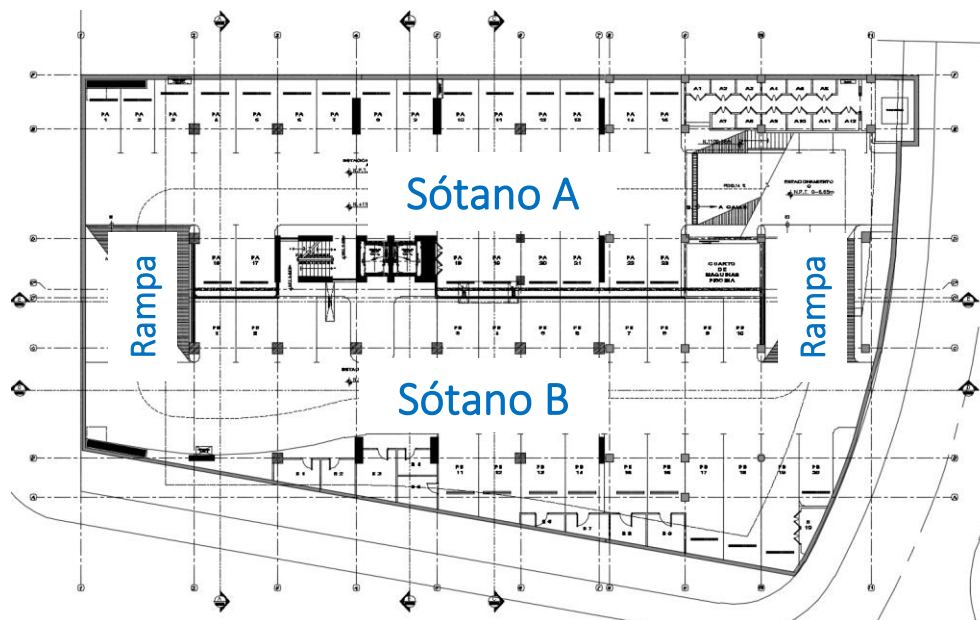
Planta de los sótanos A y B de los parques del presente proyecto
